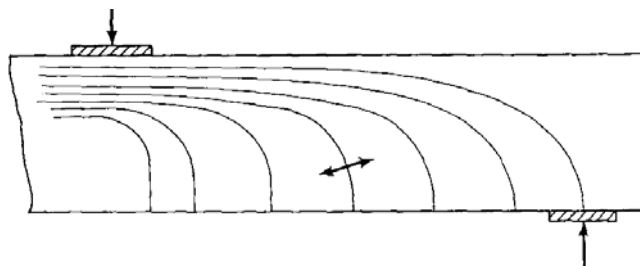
Trajetórias das tensões principais de compressão para vigas não fissuradas – FONTE: MacGregor, 2005
